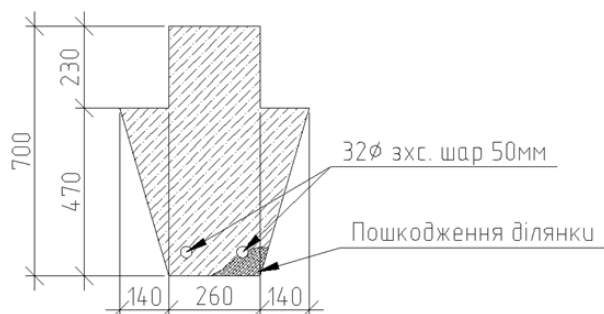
Поперечний переріз збірного залізобетонного ригеля перекриття
